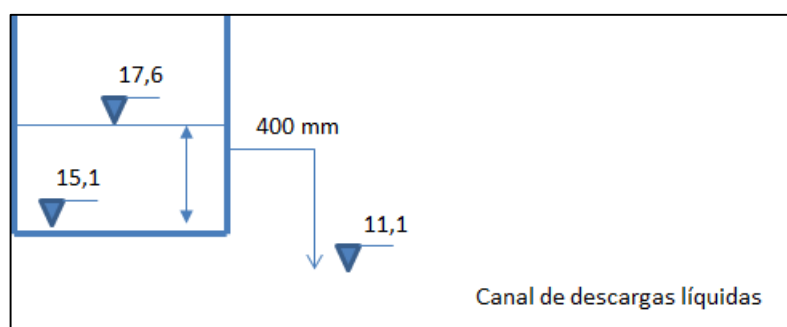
Vista geral das descargas de fundo a serem instaladas nos decantadores implantados em segunda etapa na ETA Bolonha
